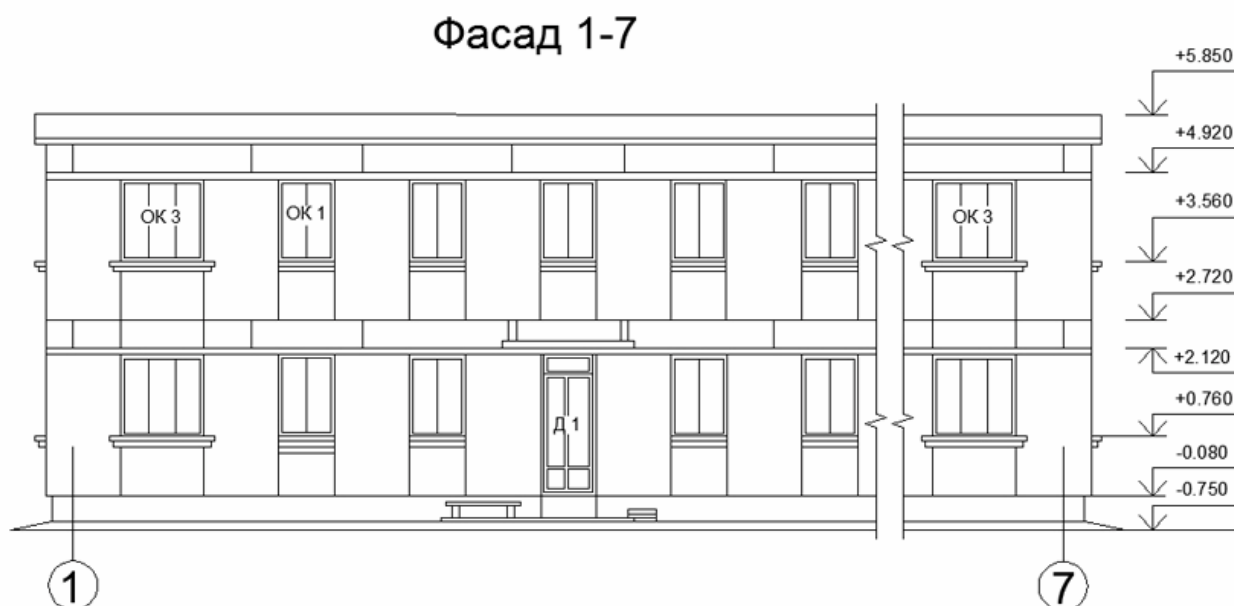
Фасад 1–7 крупноблочного жилого дома
